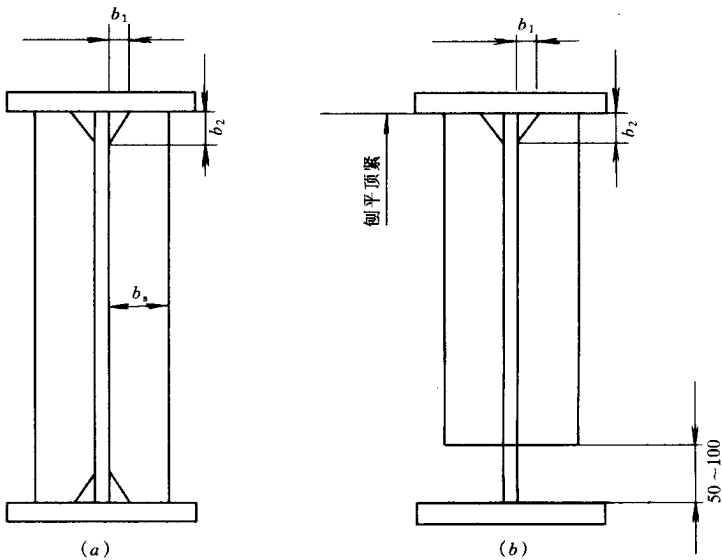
实腹吊车梁横向加劲肋板连接构造示意
